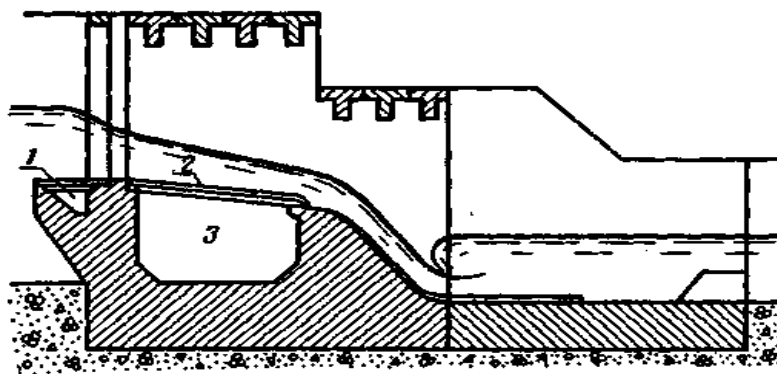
Глубинный решетчатый водозабор с наносоперехватывающей траншеей: 1 – наносоперехватывающая траншея; 2 – донная решетка; 3 – водозаборная галерея
